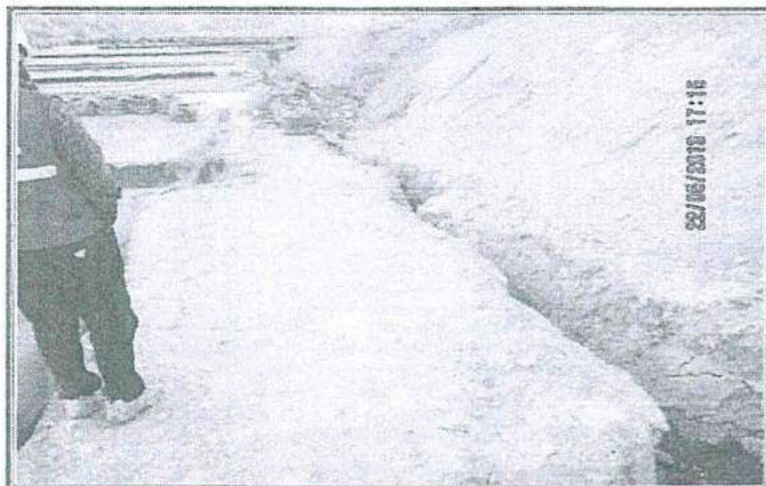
Hallazgo N° 2. Botadero 3, Sistema de Tratamiento del drenaje y Subdrenaje. Para la colección y tratamiento del drenaje y subdrenaje, construyo este cana! y pozas para implementar un sistema wetland. Se constató huellas que las aguas no fueron colectados por el canal y no ingresaron a las pozas wetland.
